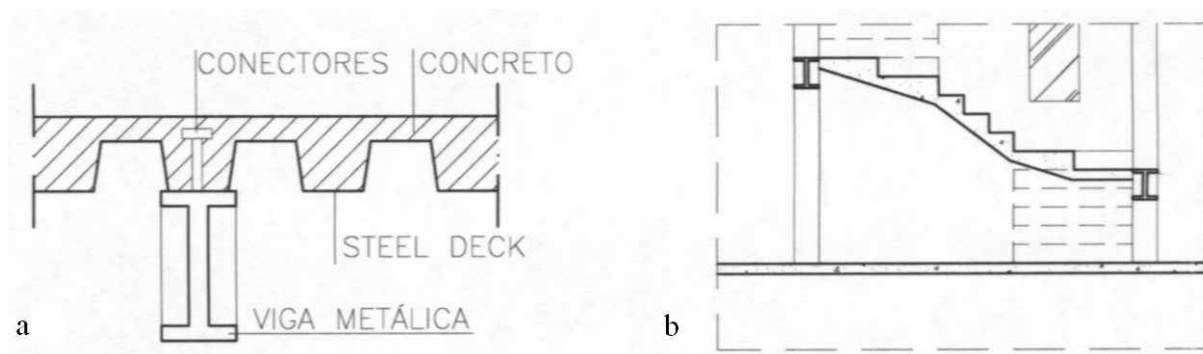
Detalhes da estrutura do projeto. a) vigas e lajes; b) escada moldada *in loco*.
